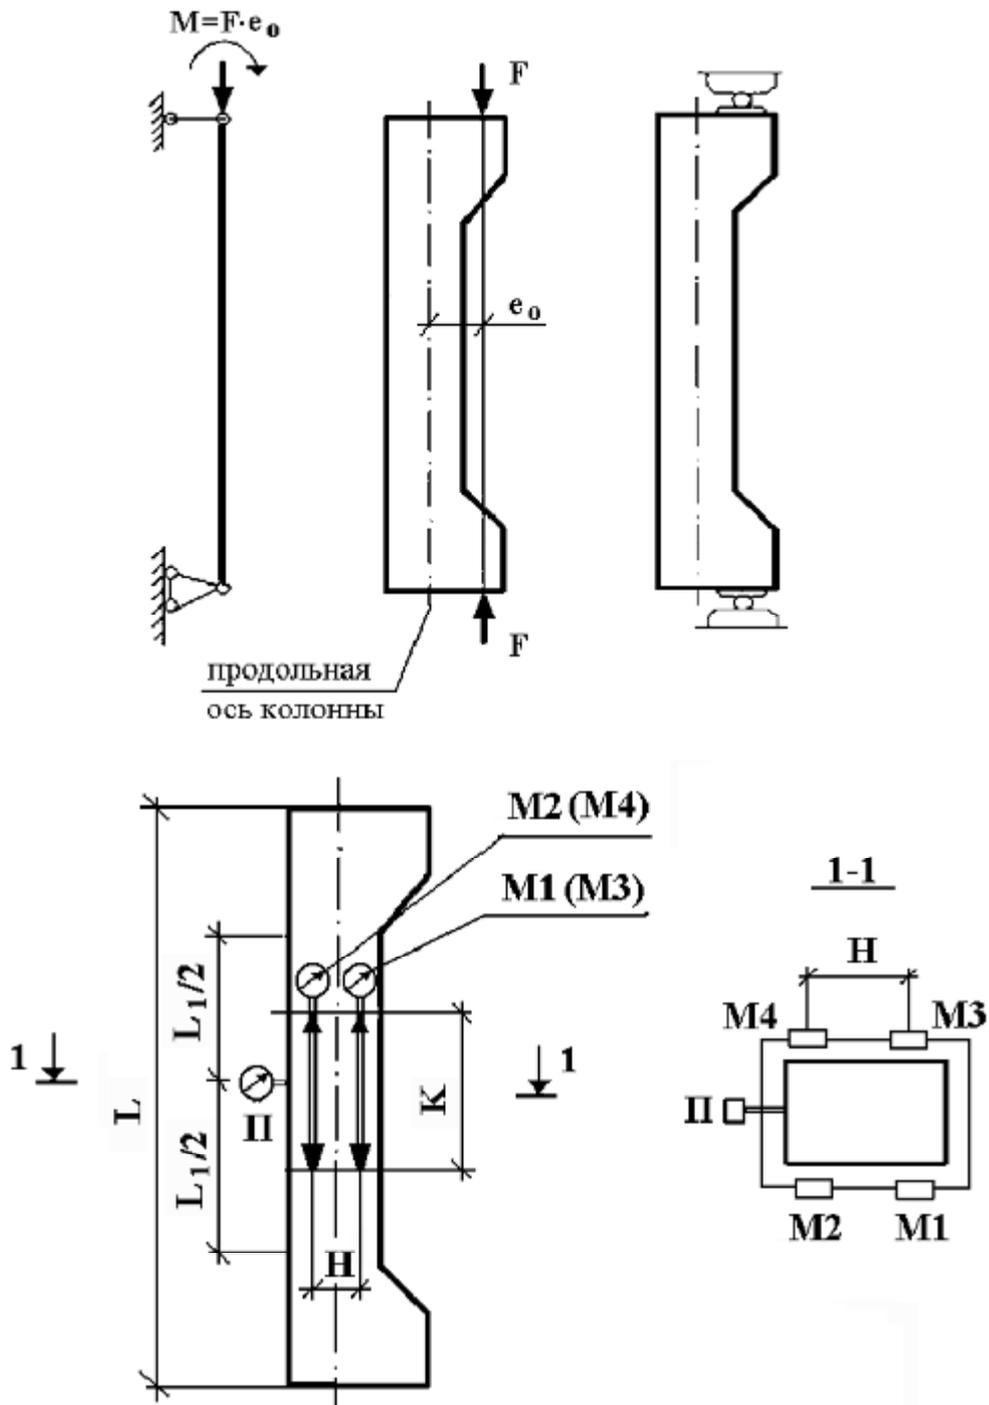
Схема загрузки образца и расположения измерительных приборов.
